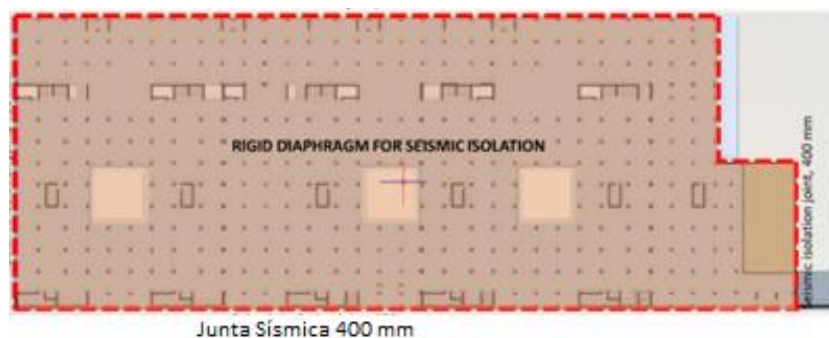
Ilustração do esquema de junta sísmica ao nível da laje de isolamento de base- piso -3 (ARSLVT, 2026)
